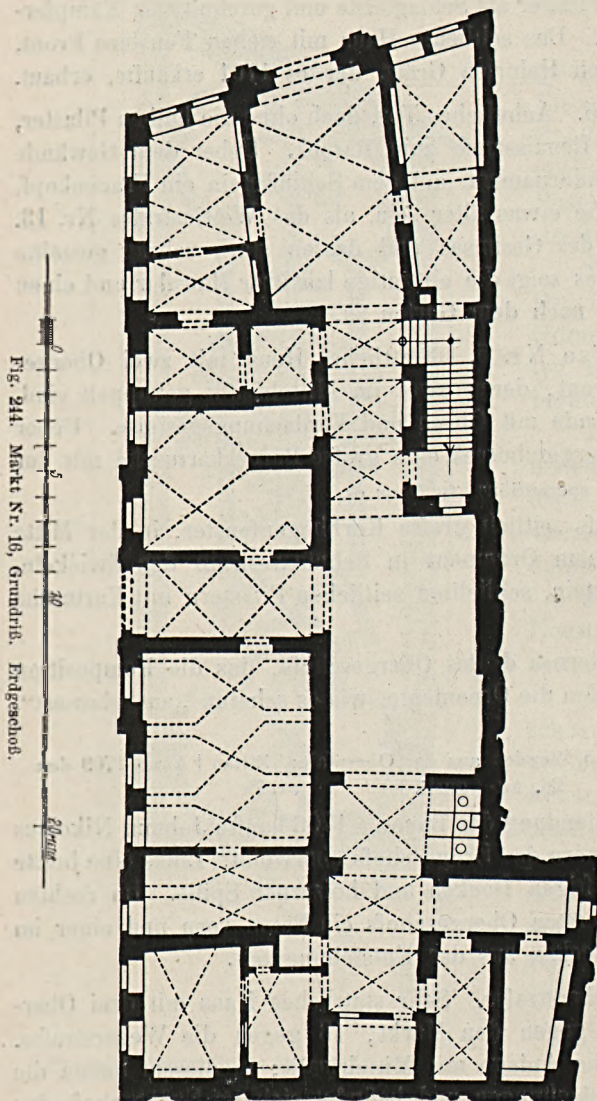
Markt Nr. 16, Grundrifs, Erdgeschoss.
